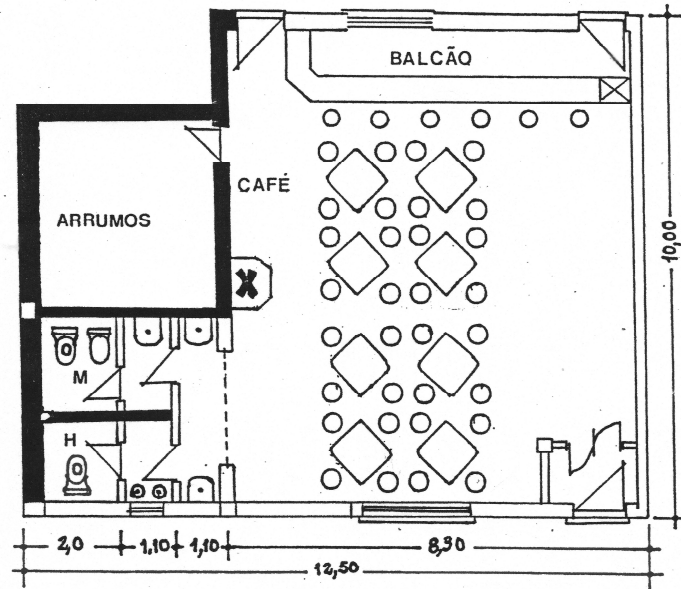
Planta original do café, Fonte: Dona do estabelecimento, 2024
